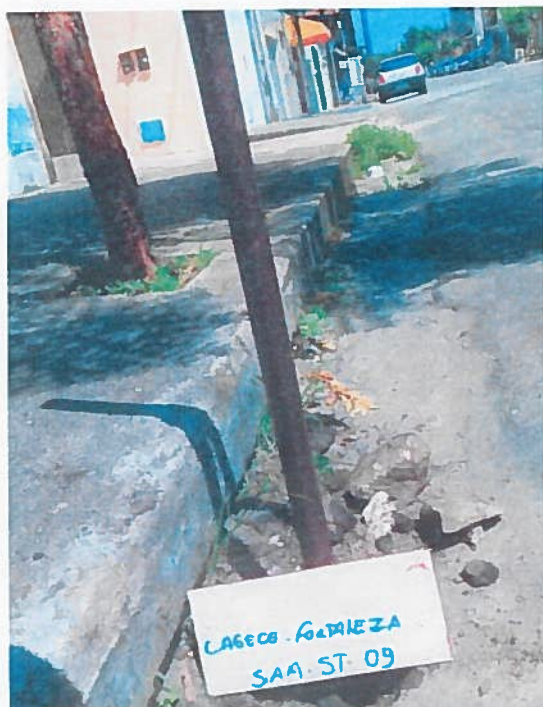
Detalhe do local onde foi realizado o ST-09.
